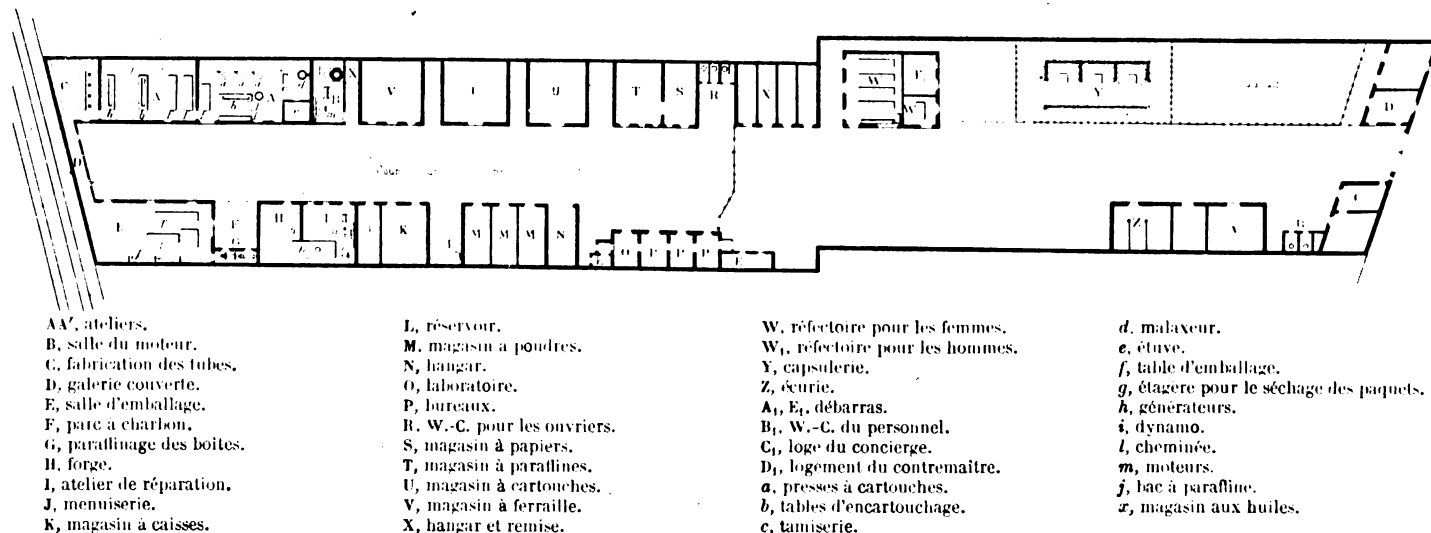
Plan général de l'usine de Saint-Denis pour la fabrication des explosifs de sûreté.
